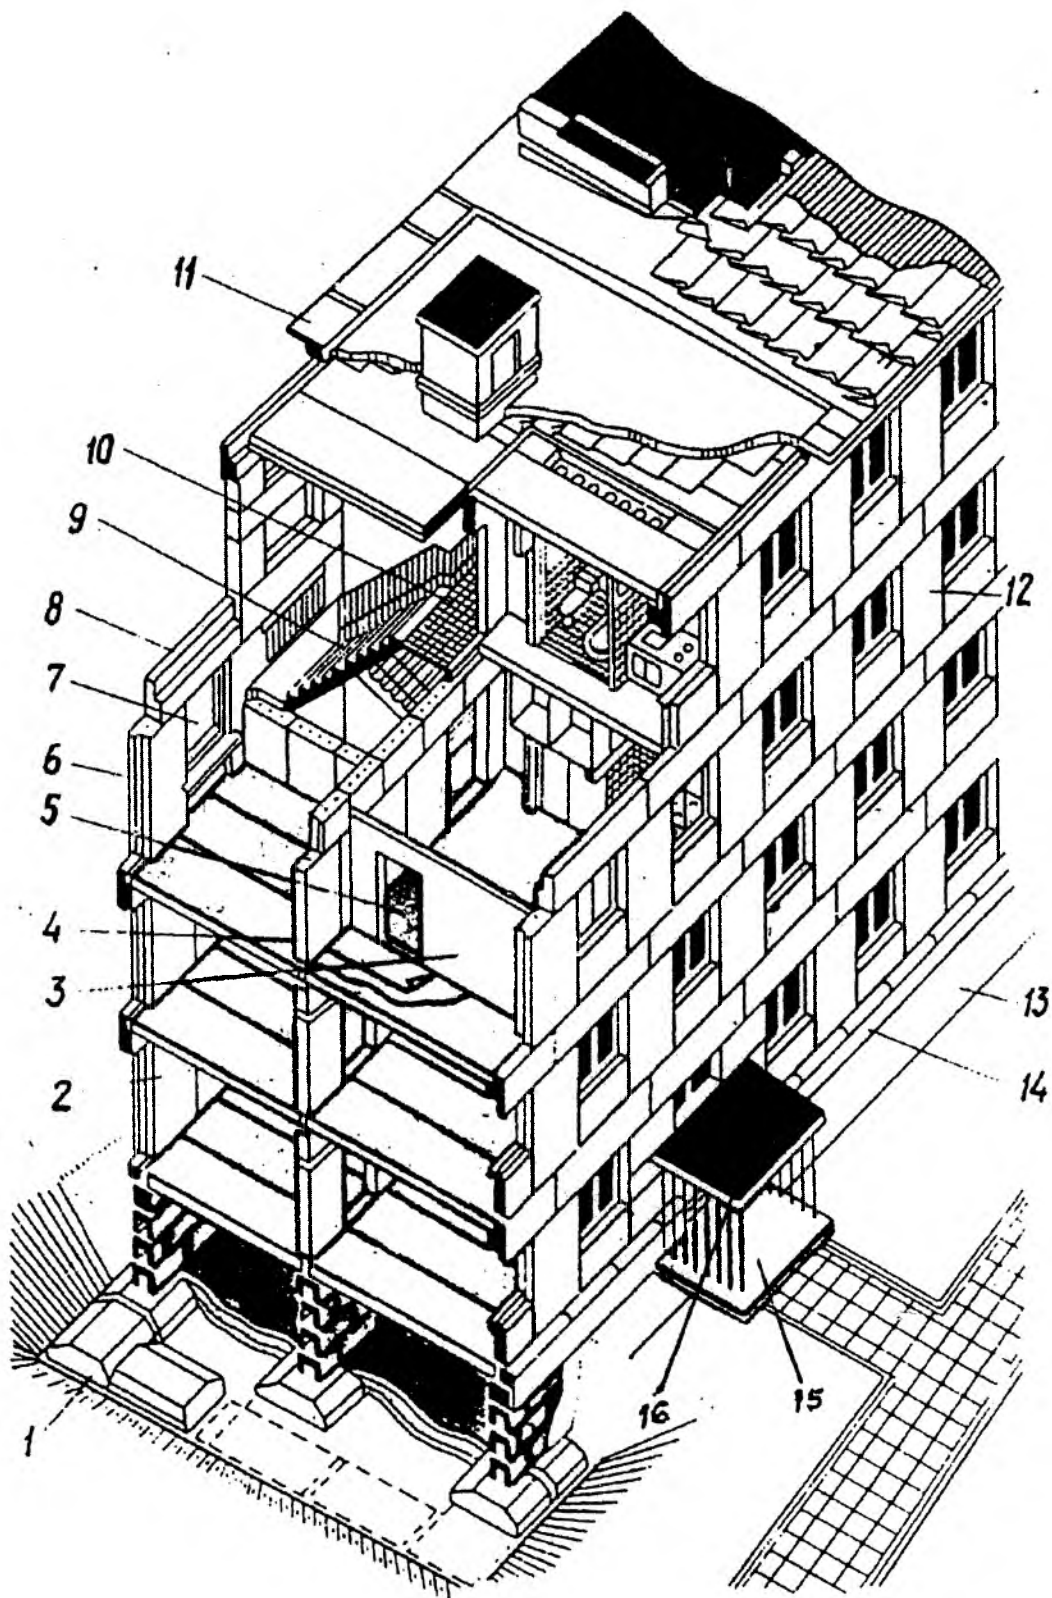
Основные элементы зданий: 1 – фундамент; 2 – междуэтажное перекрытие; 3 – перегородка; 4 – внутренняя капитальная стена; 5 – дверной проем; 6 – наружная капитальная стена; 7 – оконный проем; 8 – перемычка; 9 – лестничный марш; 10 – лестничная площадка; 11 – карниз; 12 – простенок; 13 – отсостка; 14 – цоколь; 15 – входная площадка; 16 – козырек
